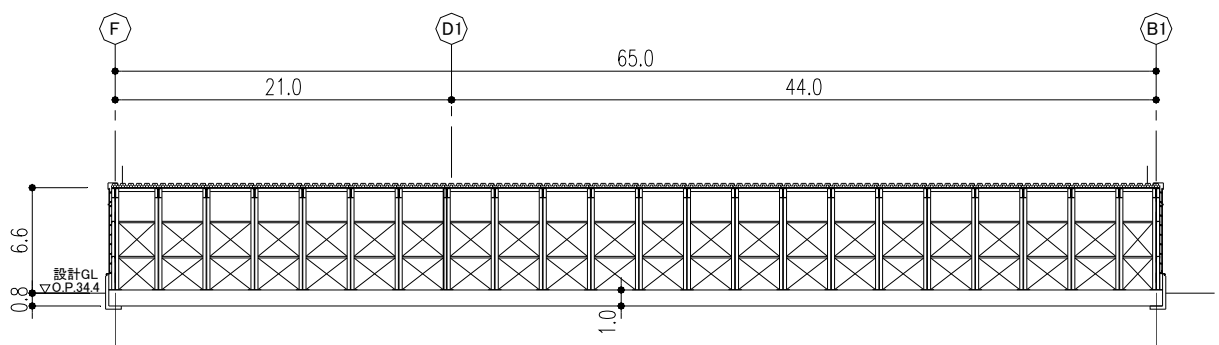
6 設備棟 B-B断面図 (EW 方向) (単位 : m)
